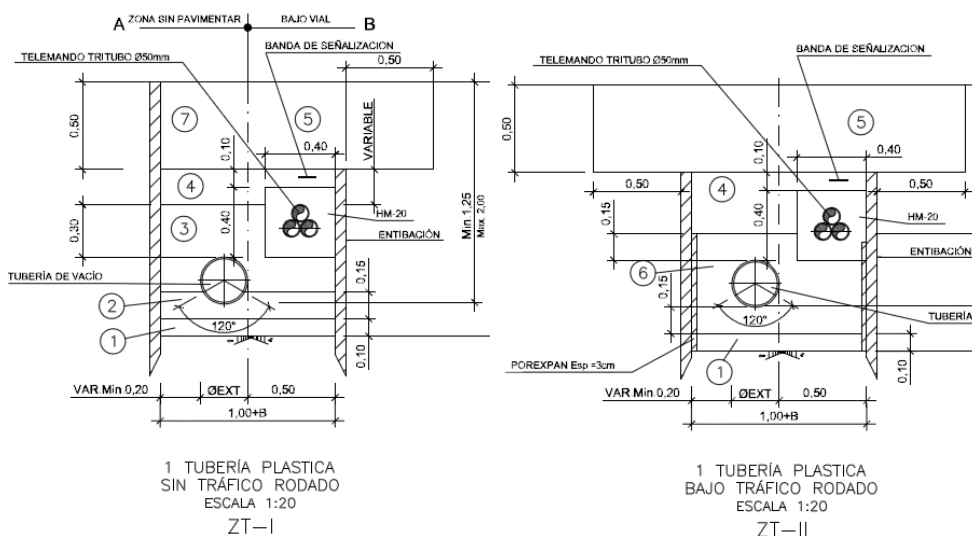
Zanjas tipo de proyecto para colocación de una sola tubería
